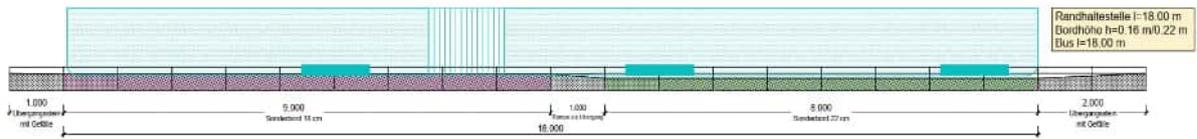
Randhaltestelle mit einer Ausbaulänge von 18 m
